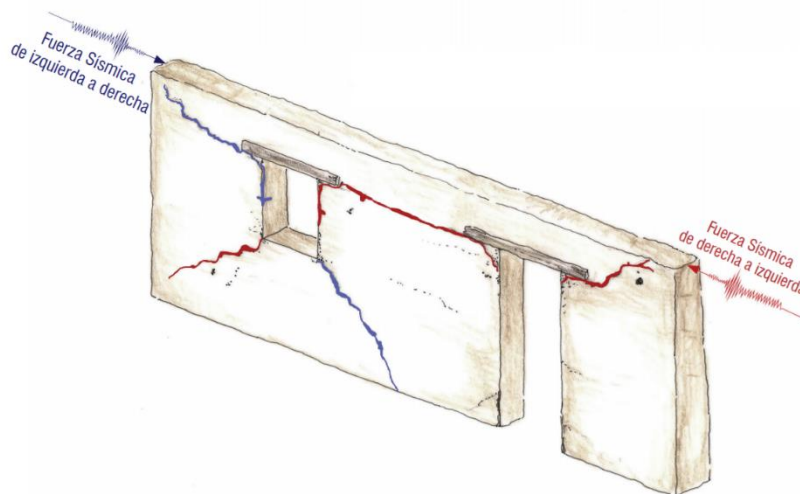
Grietas diagonales en muros (\*Fichas para reparación de viviendas de adobe Ministerio de Vivienda, Construcción, y Saneamiento)
